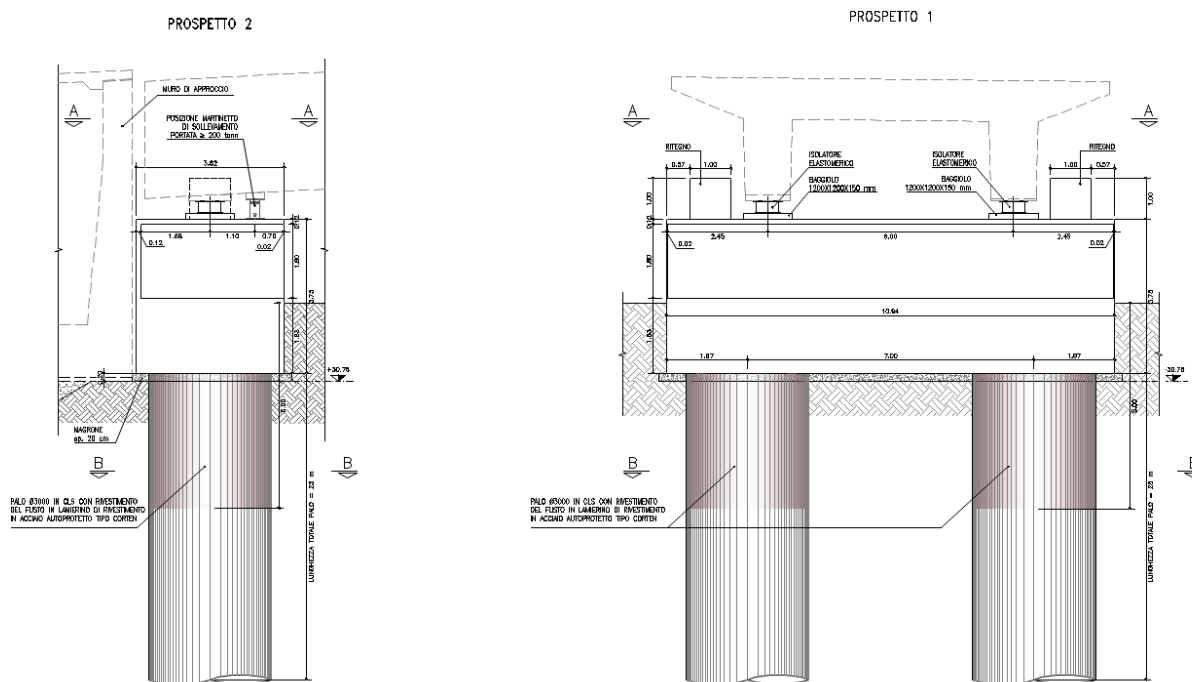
3: Sezione trasversale su spalla A e B
